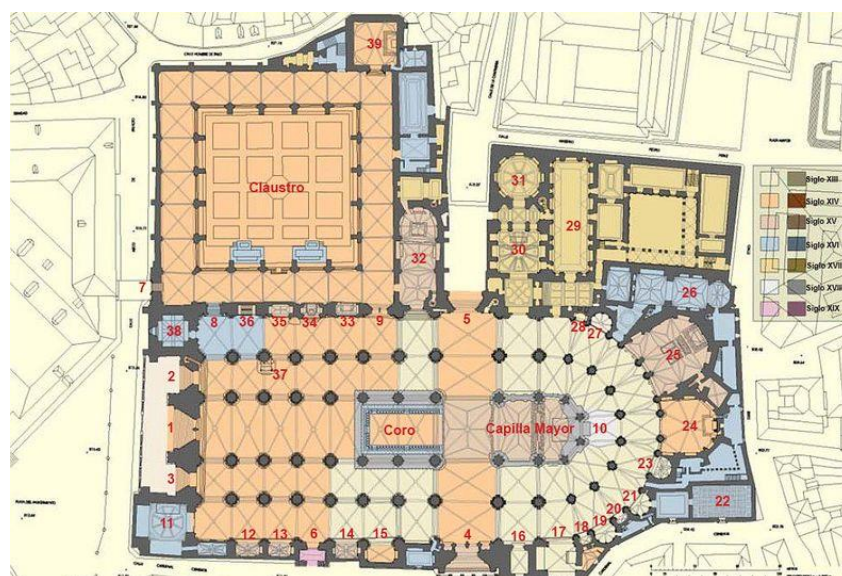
Planta con la cronología de la *catedral de Toledo*. Fuente: [https://www.urbipedia.org/hoja/Catedral de Santa Mar% C3% ADA de Toledo](https://www.urbipedia.org/hoja/Catedral de Santa Mar%C3%ADa de Toledo)
